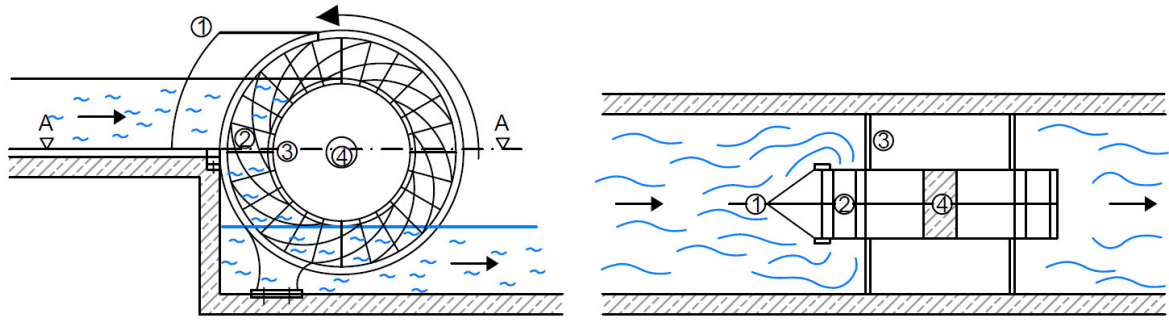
Zuppinger'sches Wasserrad: links – Längsschnitt, rechts – Grundriss, nach (Delabar 1867)
